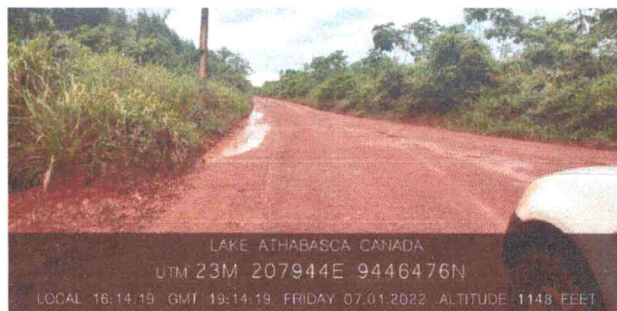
DRENAGEM PLUVIAL COMPROMETIDA
